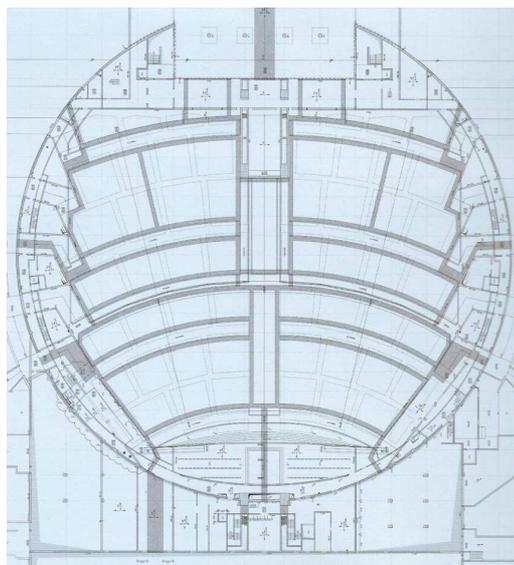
Planta da Igreja da Santíssima Trindade [3]
